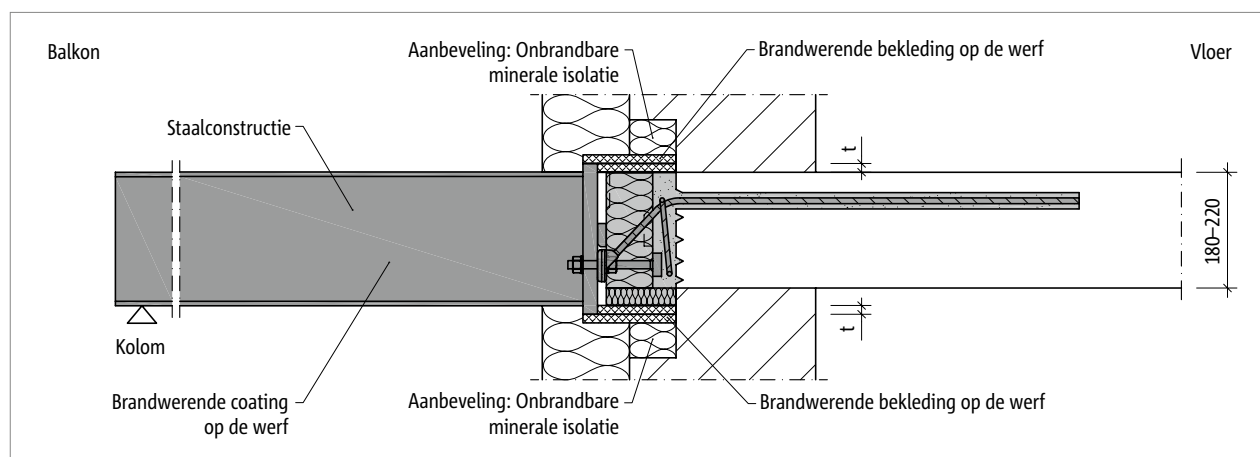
Schöck Isokorb® RT type SK: Op de werf aangebrachte brandwerende bekleding, RT type SK en brandwerend behandelde staalconstructie; doorsnede
